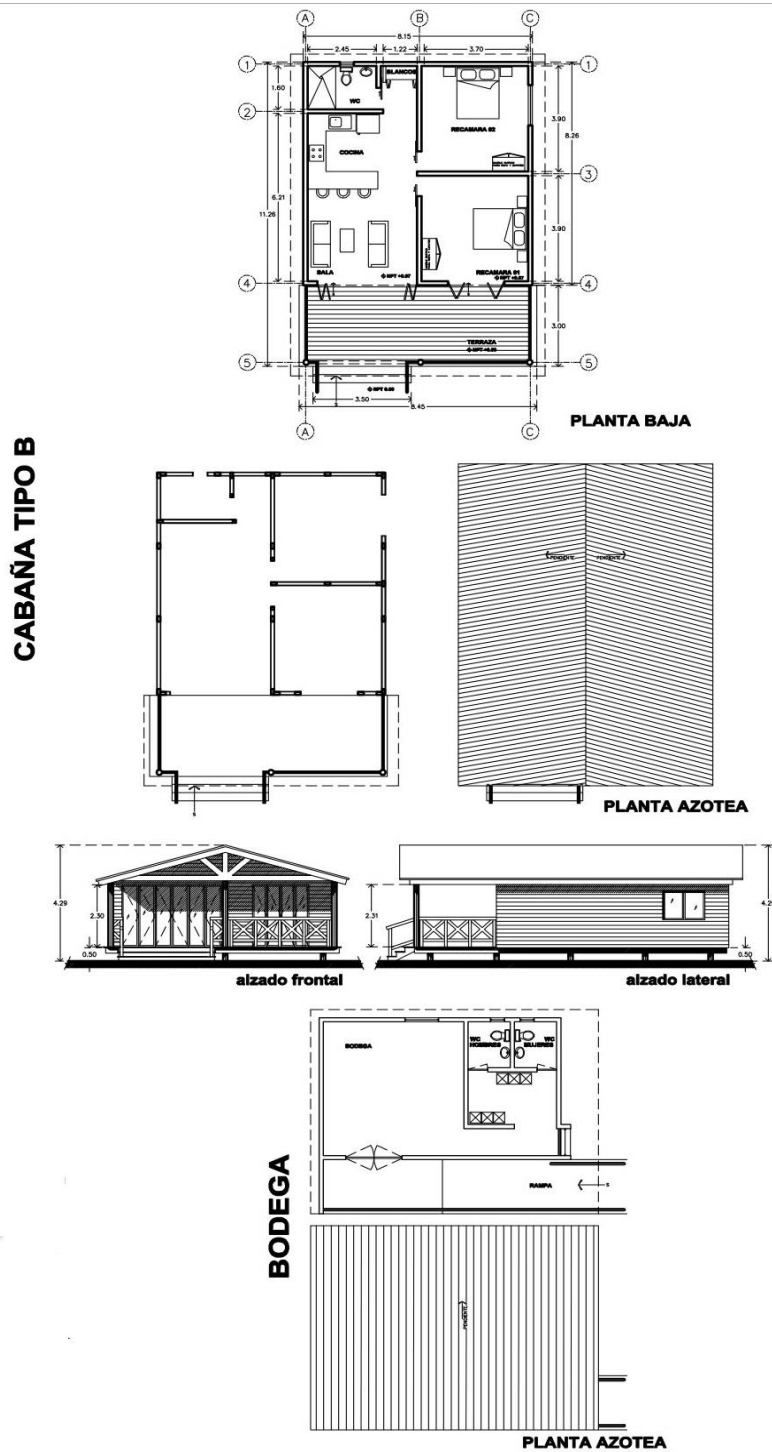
Planta arquitectónica y alzados de cabaña tipo B.
